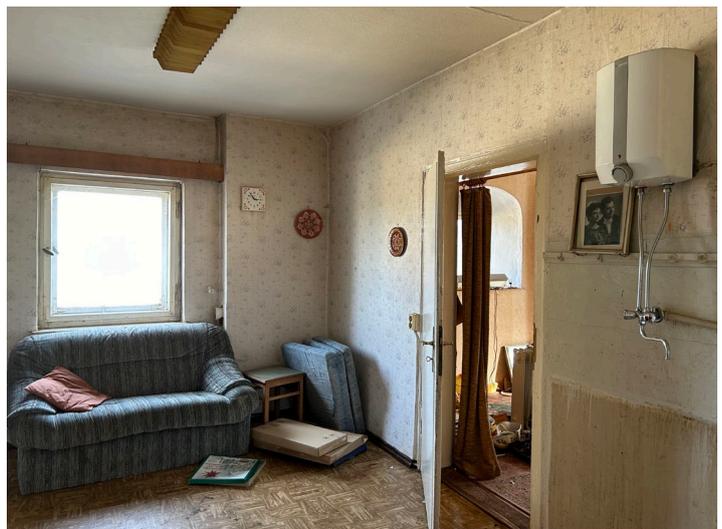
Vorderhaus, 1.Dachgeschoss, Teilansicht Zimmer zur Nordseite
